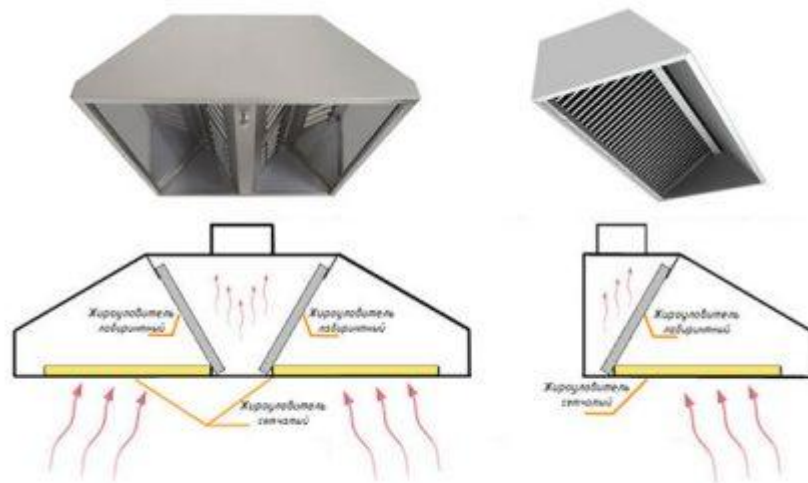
Схема размещения вытяжного зонта над рабочим местом.
